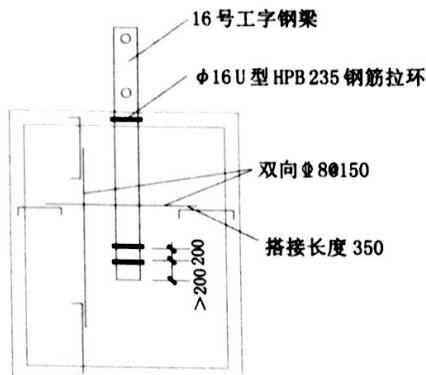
工字钢悬挑扣件式钢管脚手架平面图(单位: mm)
